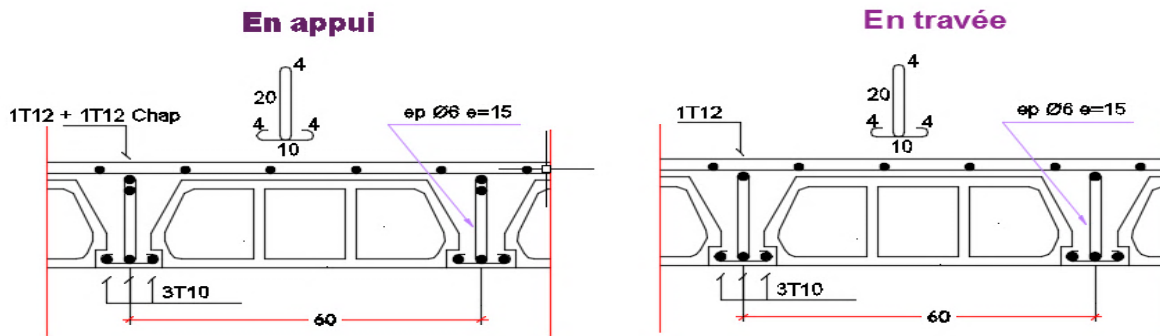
Dessin de ferrailage de la dalle à corps creux.
